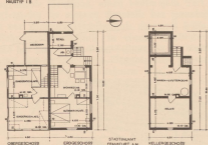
Grundriß und Ansicht des älteren Typs mit flachem Pappdach und Abfah zwischen Wohnteil und Stallanbau, hierbei Anlage eines Schornsteins im Anbau unmöglich.
